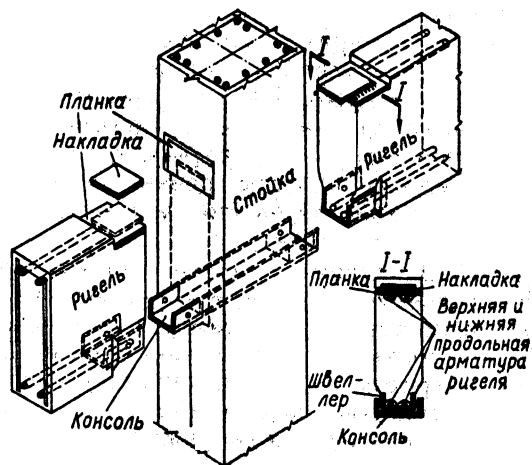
Схема сопряжения ригелей со стойкой при помощи консоли из швеллера и закладных деталей.
